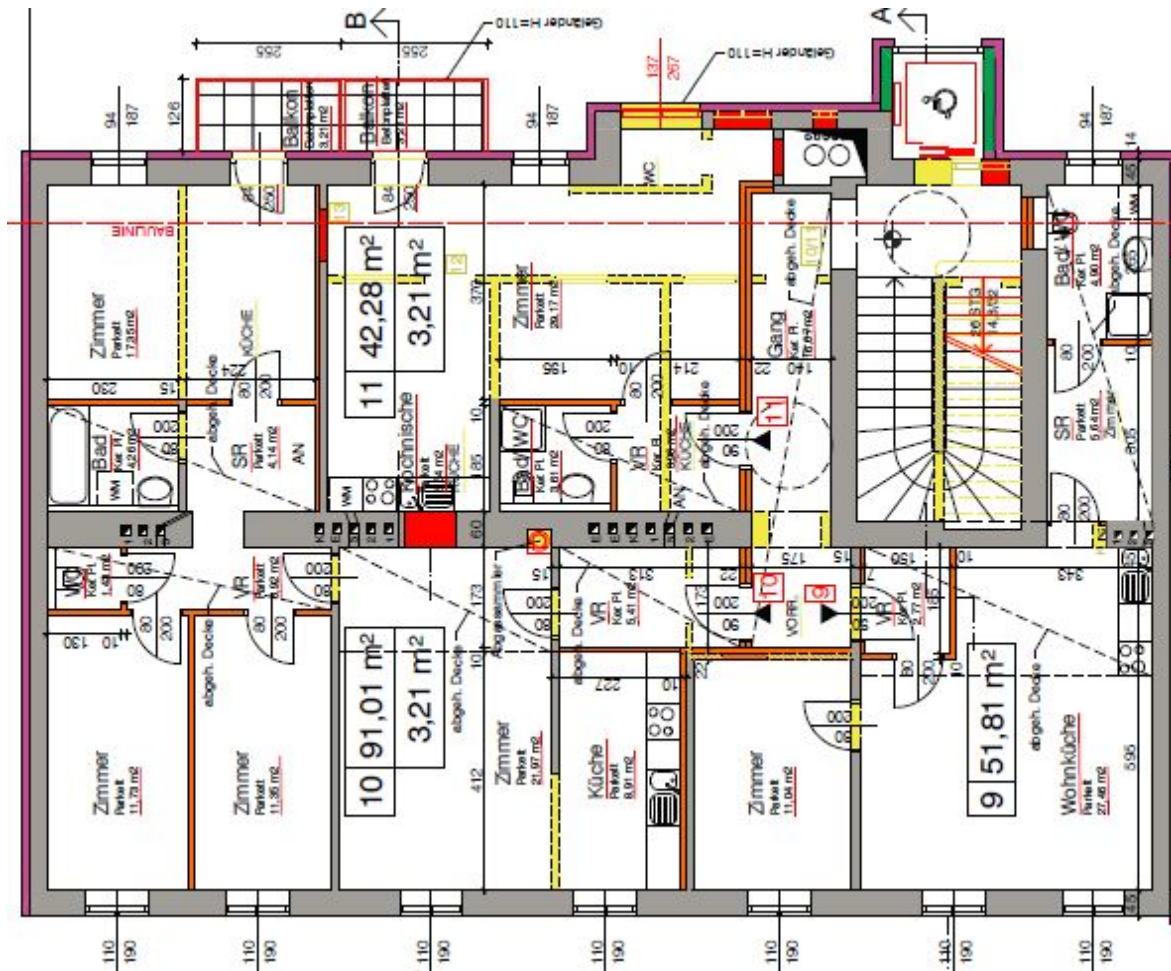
Muhrengasse 18, Grundriss 3. Stock (Quelle: Auswechslungsplan 06.07.2010)
